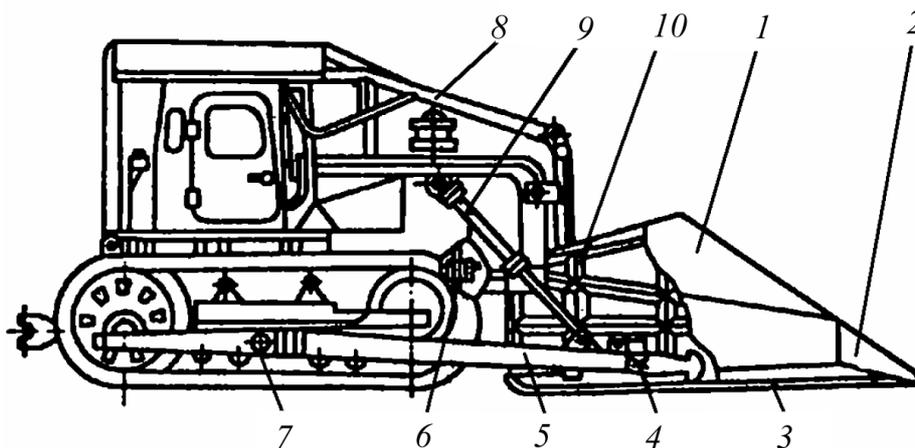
Кусторез ДП-24: 1 – отвал; 2 – носовой клин; 3 – нож; 4 – шаровая головка; 5 – толкающая рама; 6 – привод шлифовального диска; 7 – шаровые втулки; 8 – ограждение; 9 – гидроцилиндр; 10 – каркас
